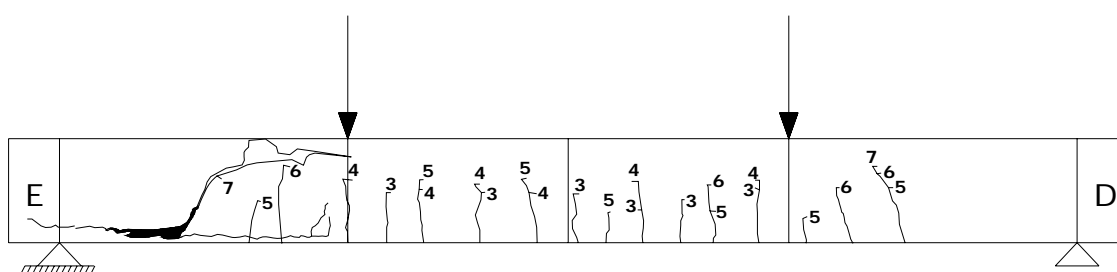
Padrão de fissuração para viga sem armadura transversal
